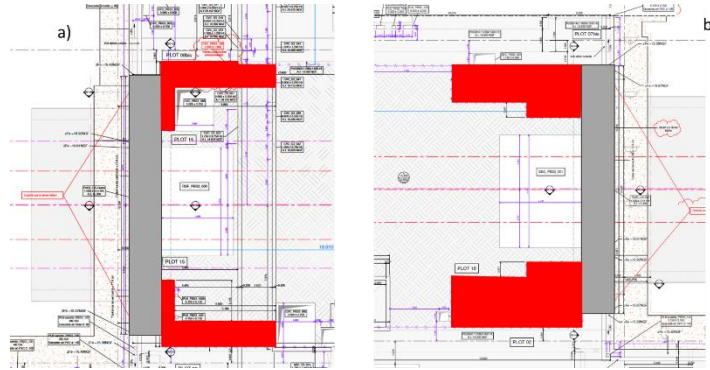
Vue en plan des consoles des liernes - a) zone Ouest - b) zone Est
